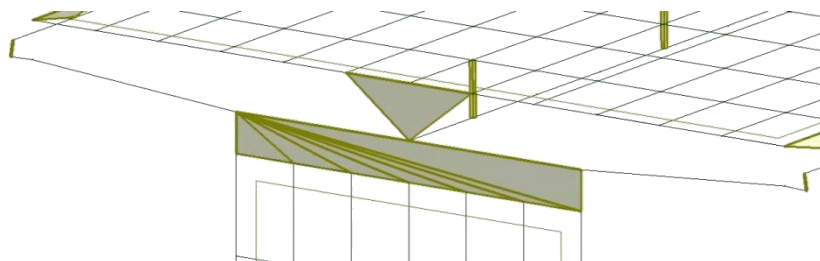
Pormenor das ligações nas extremidades da ponte
